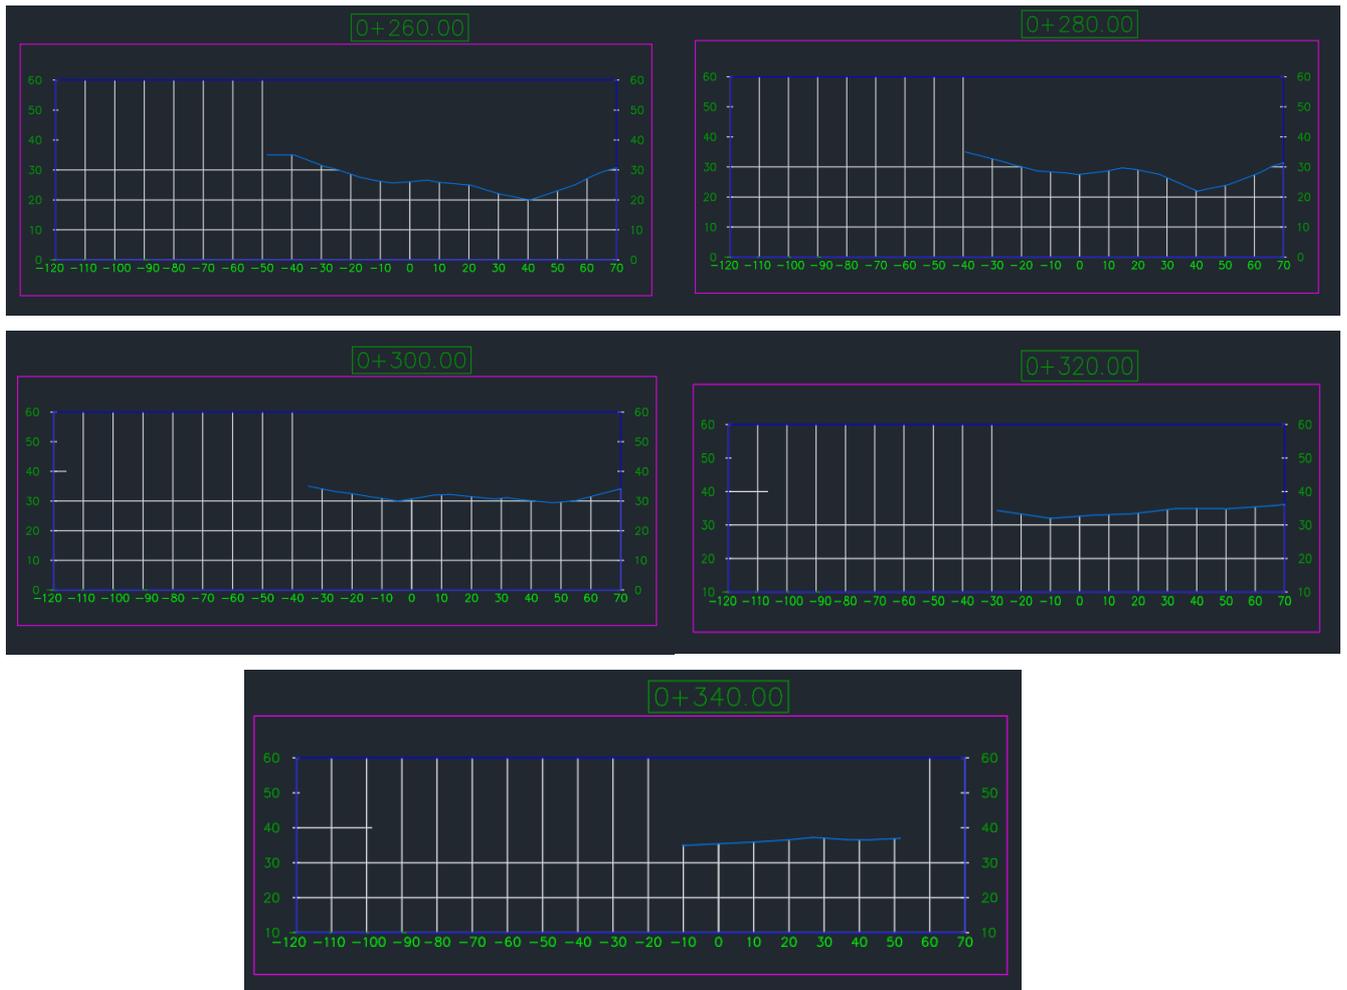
Representación de las secciones transversales de 260 a 340 m.
